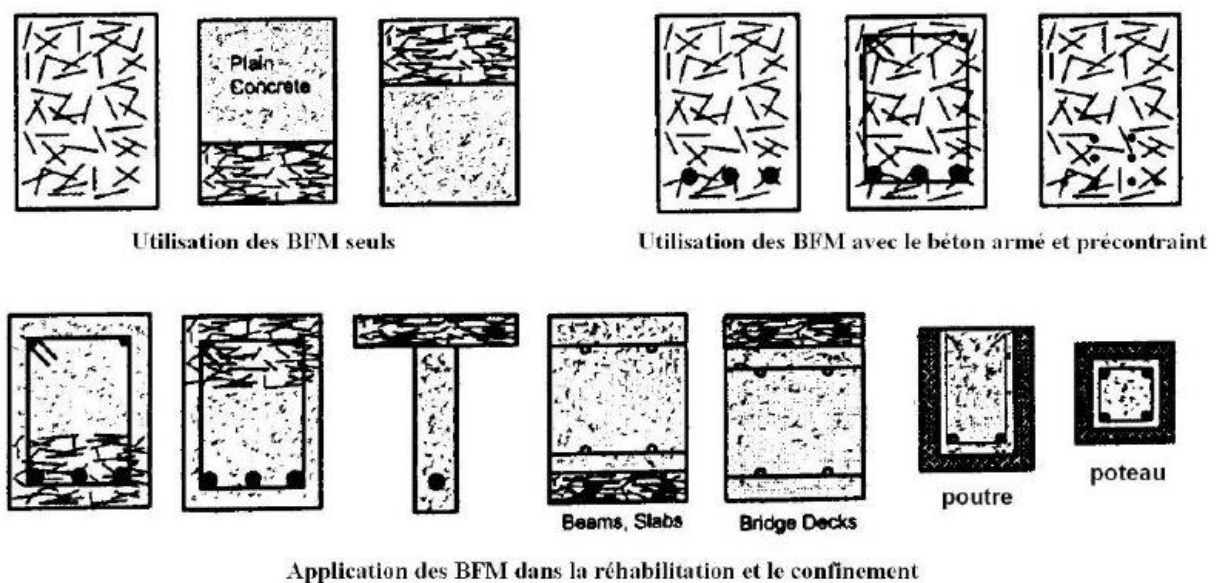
Exemples d'applications du béton de fibres. [39]
